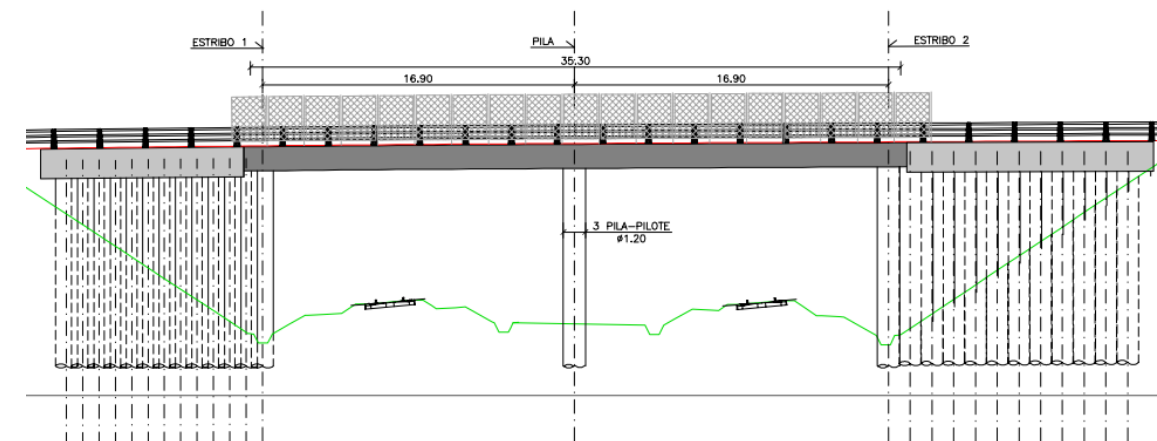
ALZADO PS ACCESO ESTACIÓN DE ELCHE Y COLADA DE SANTA TERESA P.K. 2+990
